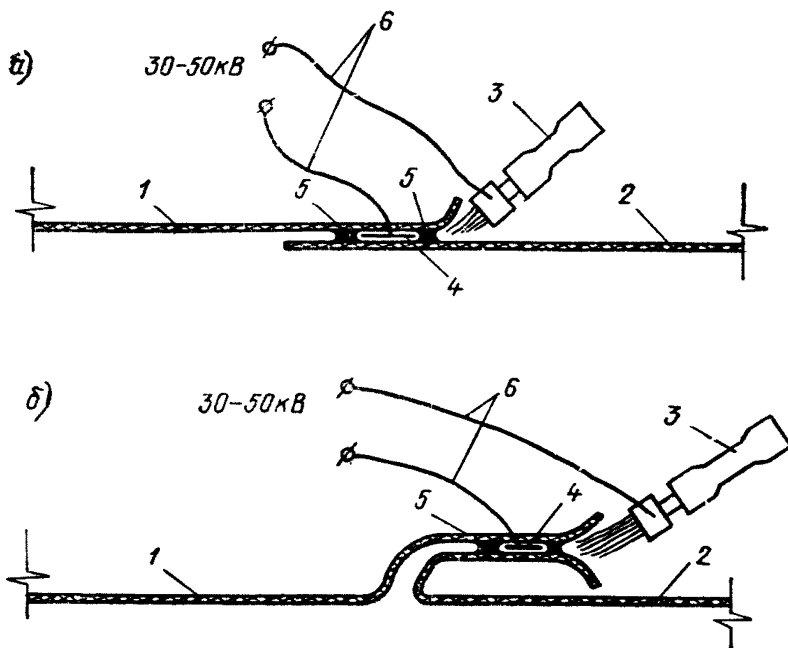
Схема проверки водонепроницаемости сварных швов а—соединение полотнищ внахлест; б—Т-образное соединение полотнищ; 1—первое полотнище; 2—второе полотнище; 3—медная щетка с ручкой из диэлектрика; 4—лента из металлической фольги; 5—сварной шов; 6—проводники высокого напряжения (источником высокого напряжения может служить, например, магдино типа М47Б-1).
